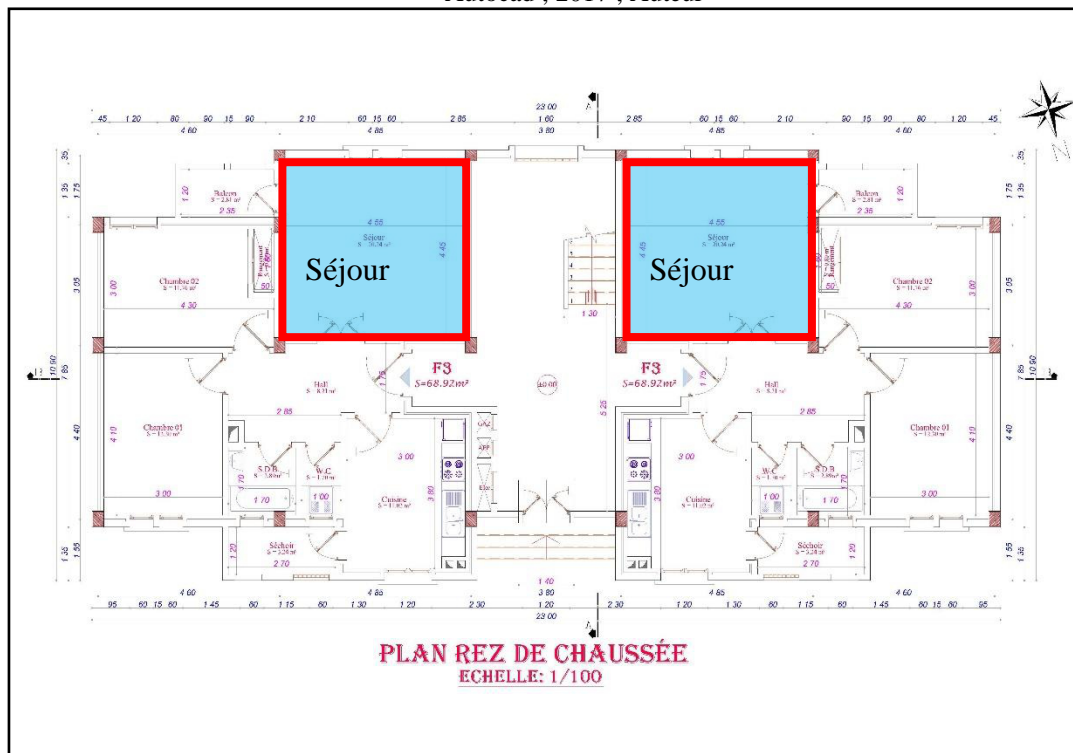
Plan RDC montre le séjour (Objet d'étude)
